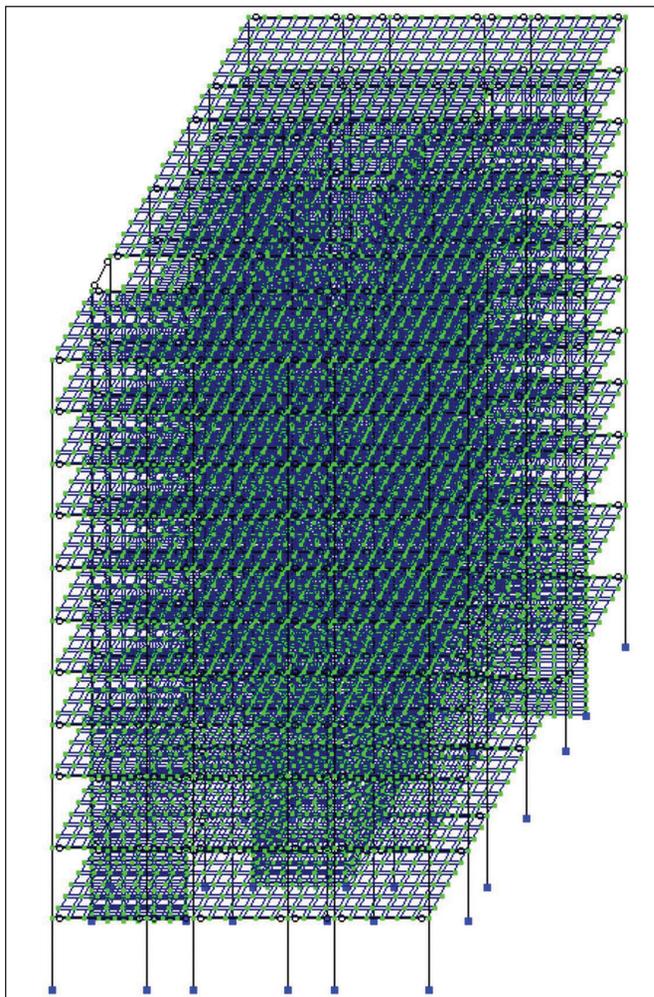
Расчетная схема каркаса здания без учета податливости узловых соединений
